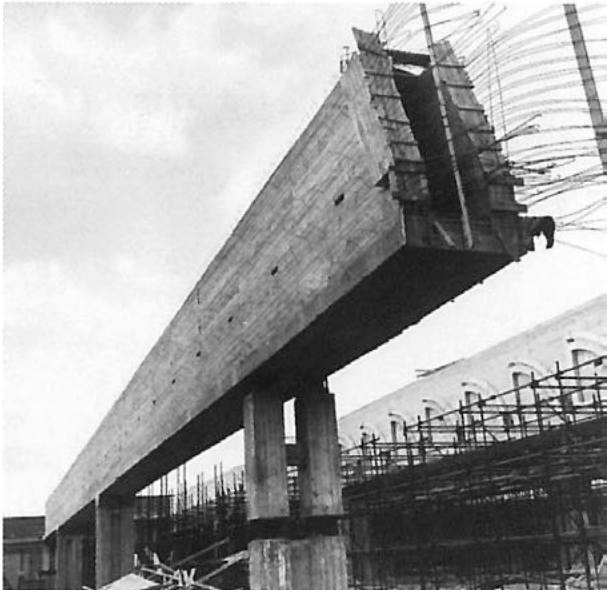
M. Zanuso, La trave cava in calcestruzzo armato dello stabilimento Necchi a Pavia, 1961.
